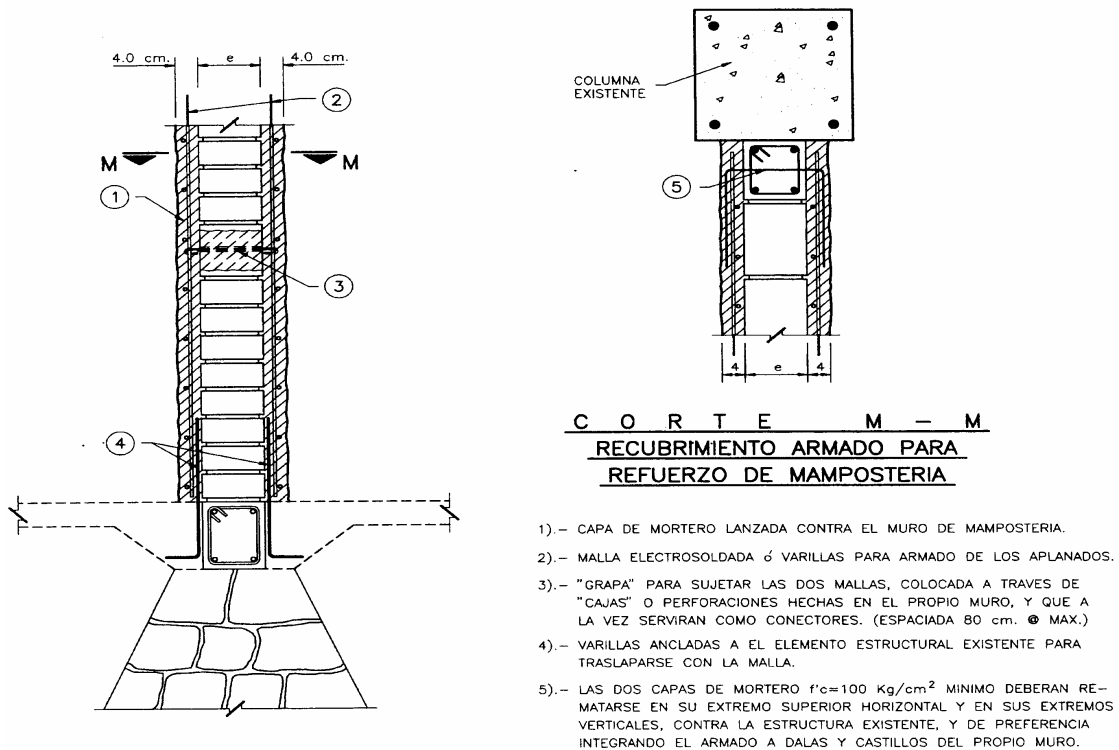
Recubrimiento armado para rehabilitación de mampostería (de la Torre, 1995)
